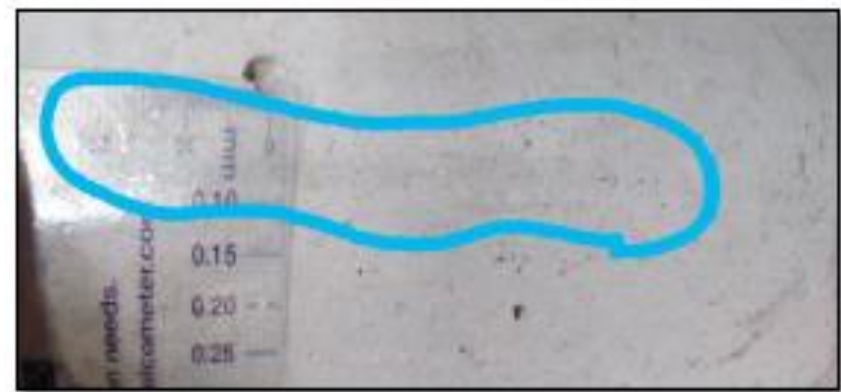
En el día 140 está grieta midió 0.03 mm de ancho.
